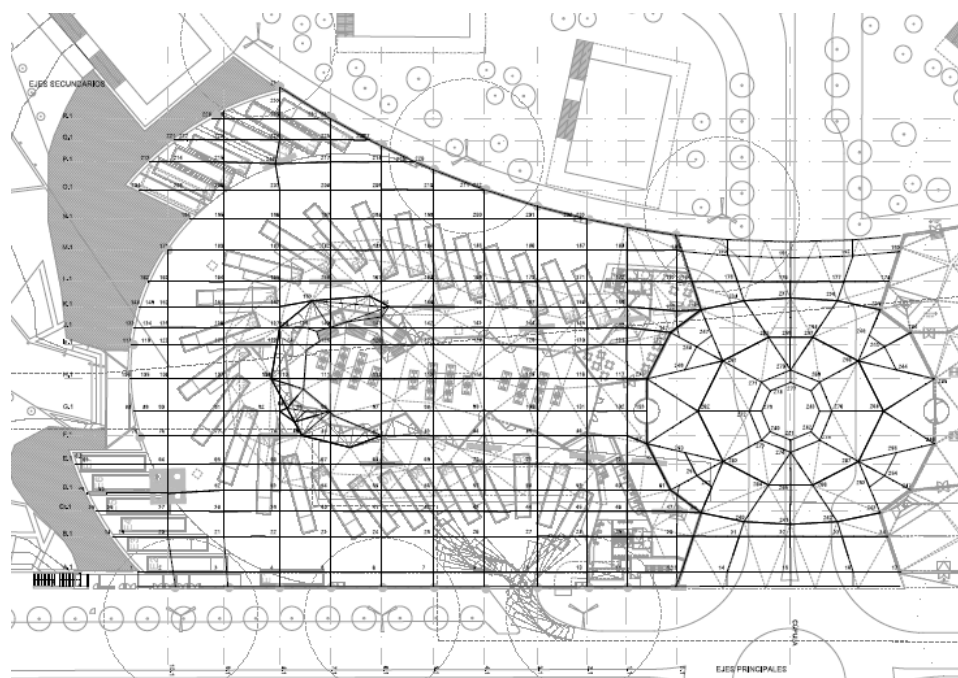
Planta de la estructura proyectada. Proyecto de Construcción
